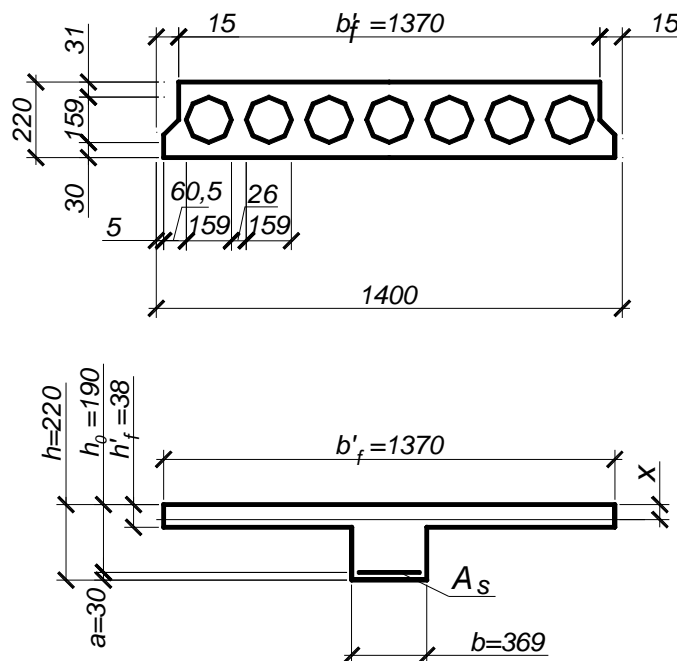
Поперечний переріз плити з круглими порожнинами
